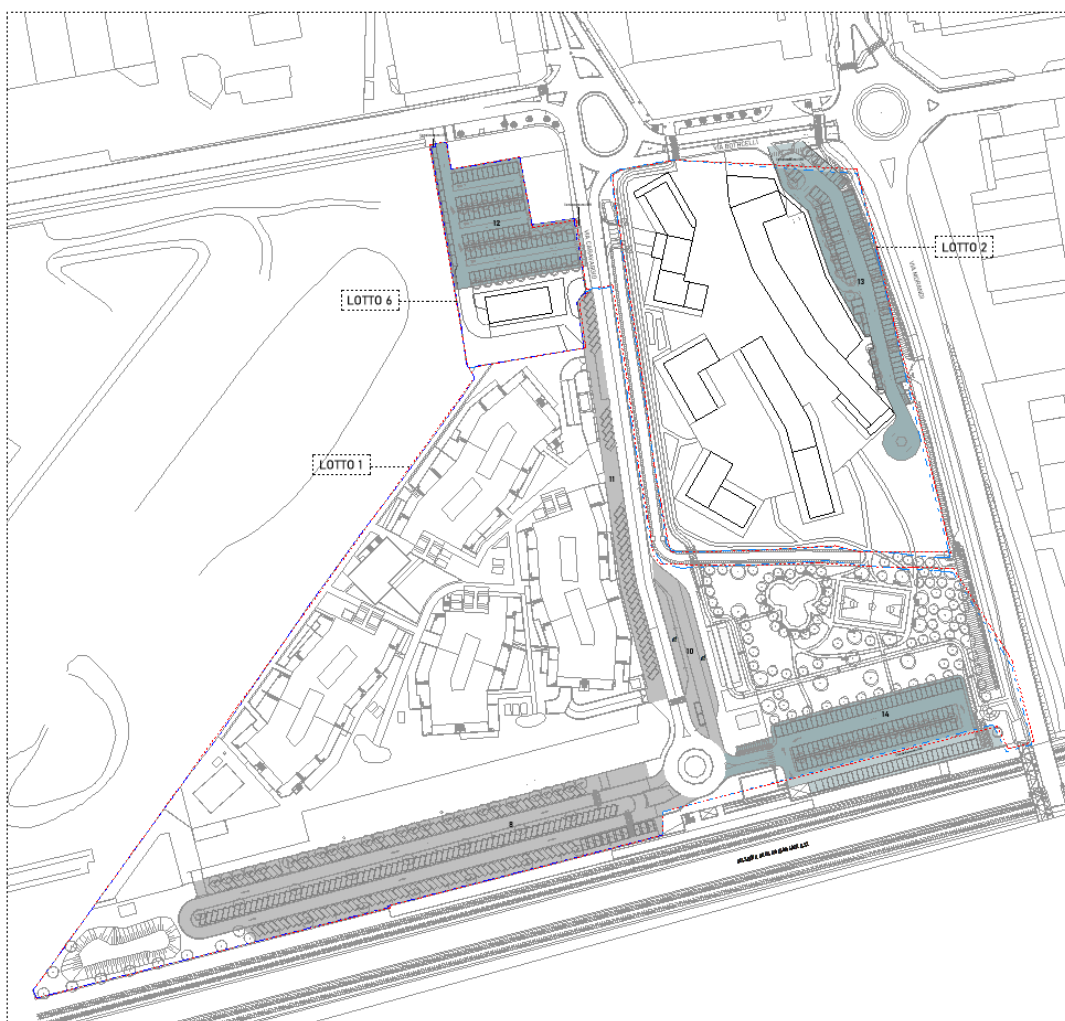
| Estratto TAV 4.5.1 - Piante parcheggi pubblici - Variante 2023
